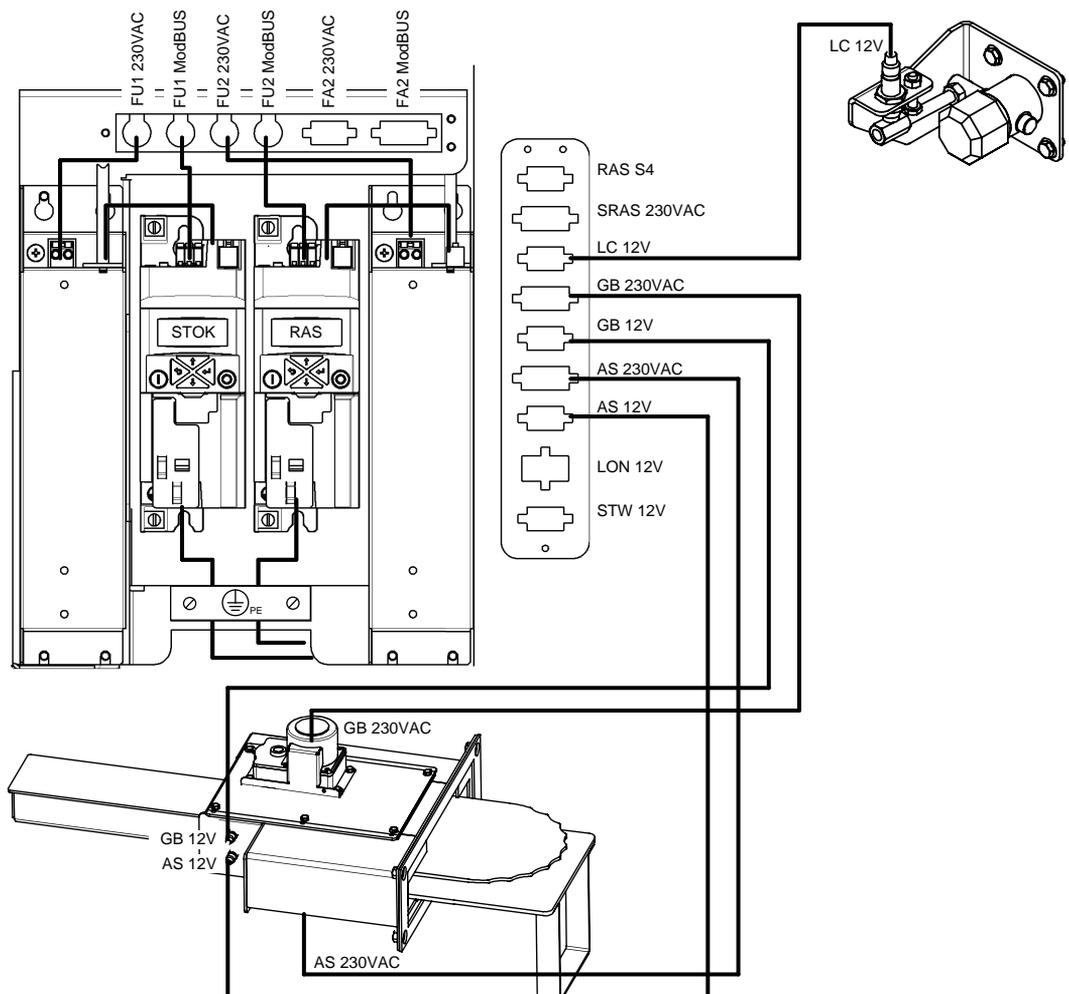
Inserire 3 interruttori di prossimità e 2 motori
